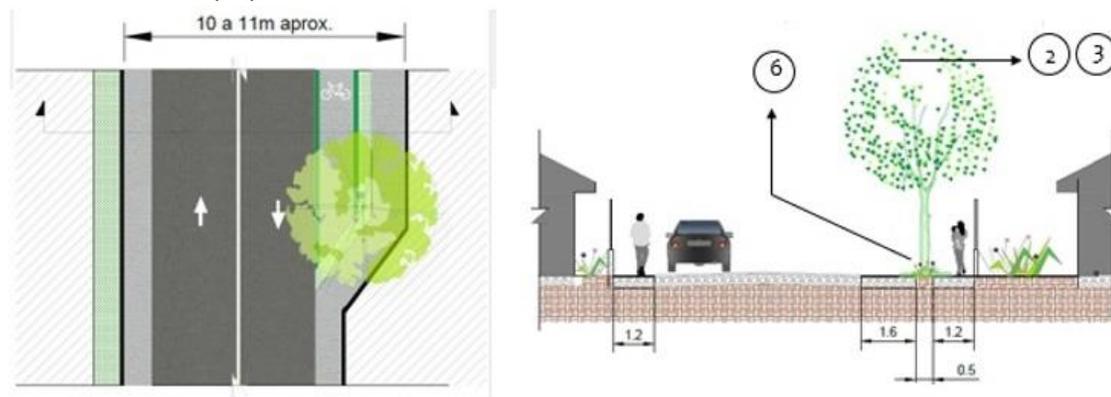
Planta arquitectónica y corte transversal propuesta calle con ciclovía demarcada.
